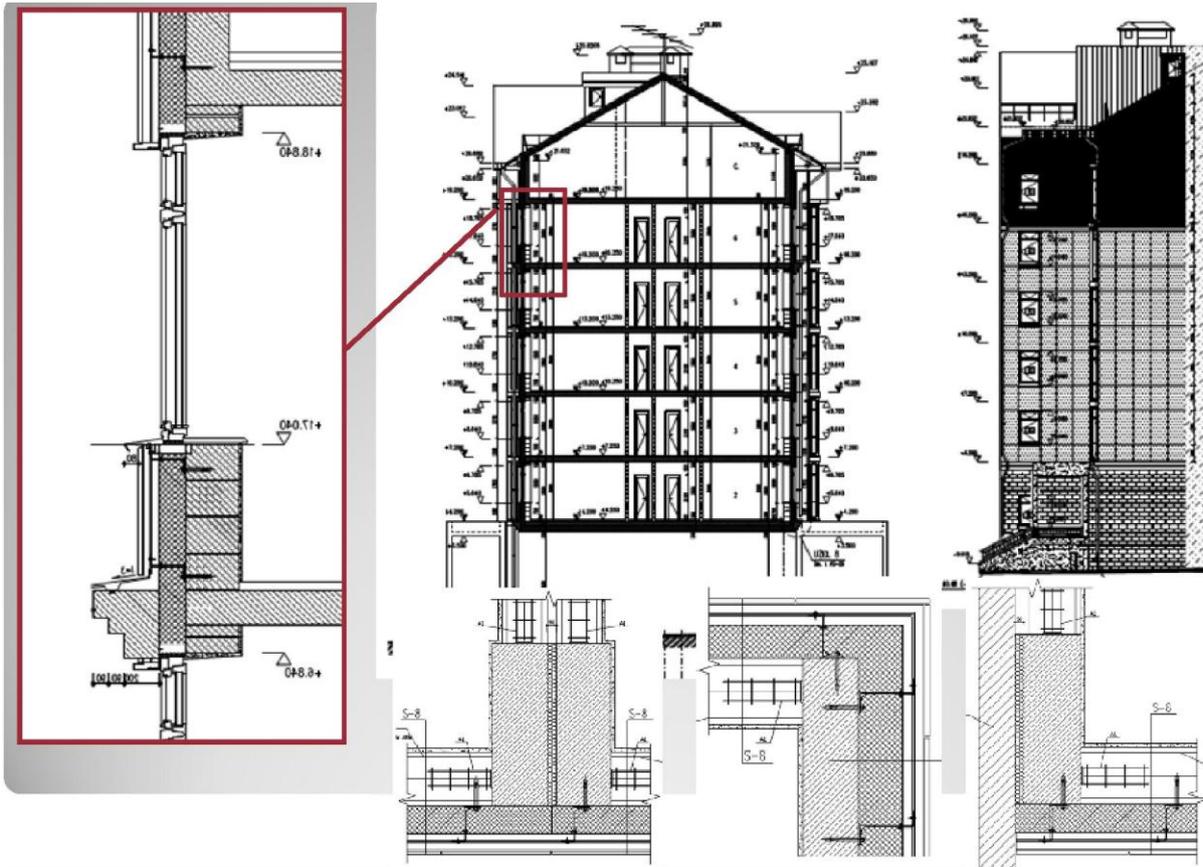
Разрез здания и узлы вентилируемого фасада здания
